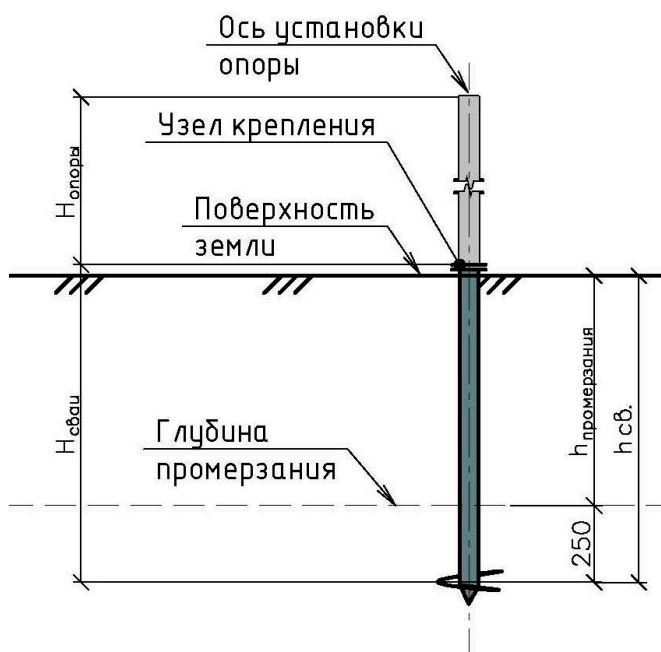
Схема устройства фундамента на винтовой свае
